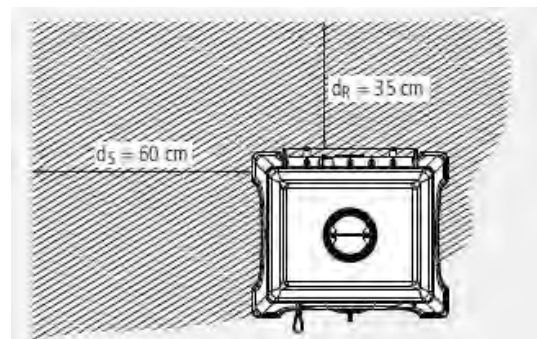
Distances minimales par rapport aux matériaux de construction ou éléments de construction inflammables
